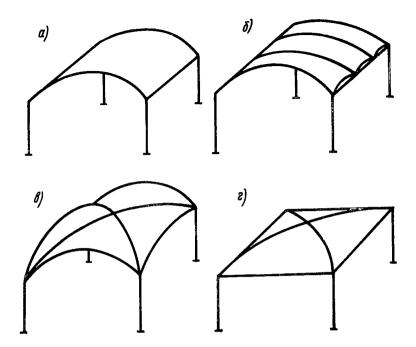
Основные типы кирпичных сводчатых покрытий и перекрытий
